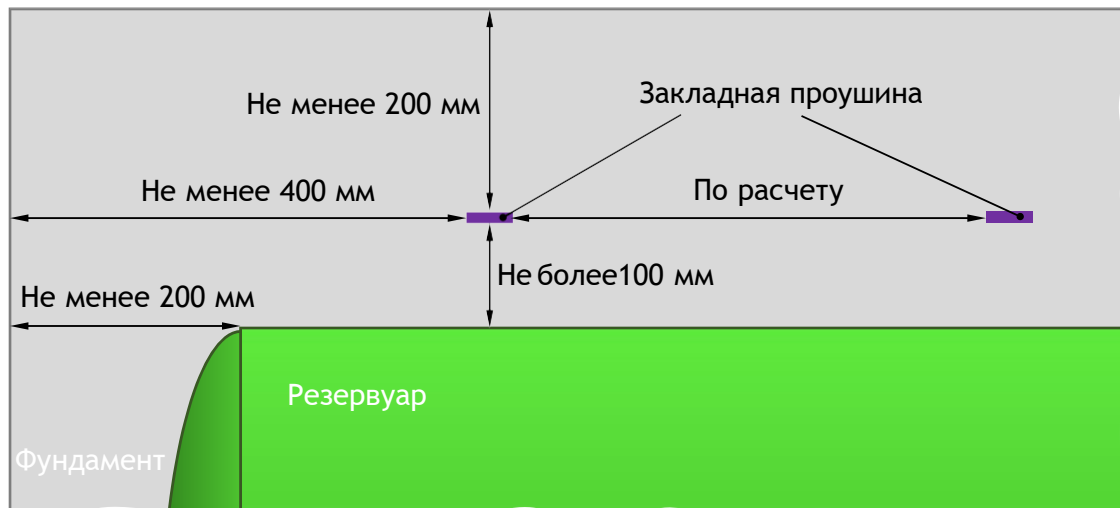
Закладка проушин на фундаментной плите (вид сверху)
